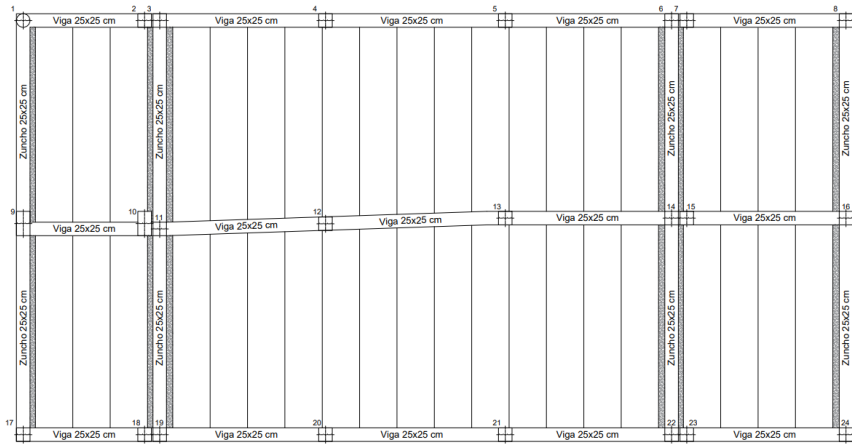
Distribución de pilares, vigas y viguetas. 2024. Fuente: Propia
